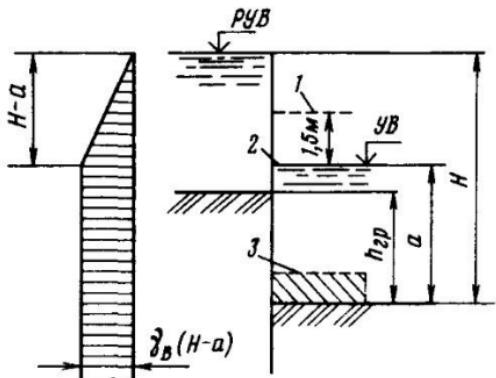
Расчетная схема для определения усилий в элементах шпунтового ограждения с одним ярусом креплений (эпюра активного давления грунта и воды заштрихована)
